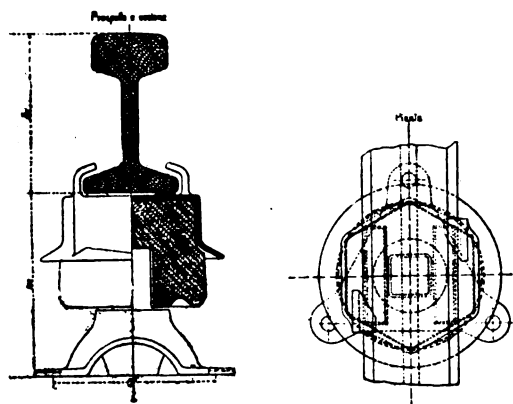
, 11 e 12. - Terza rotaia e relativo isolatore. — Prospetto, sezione e pianta.
